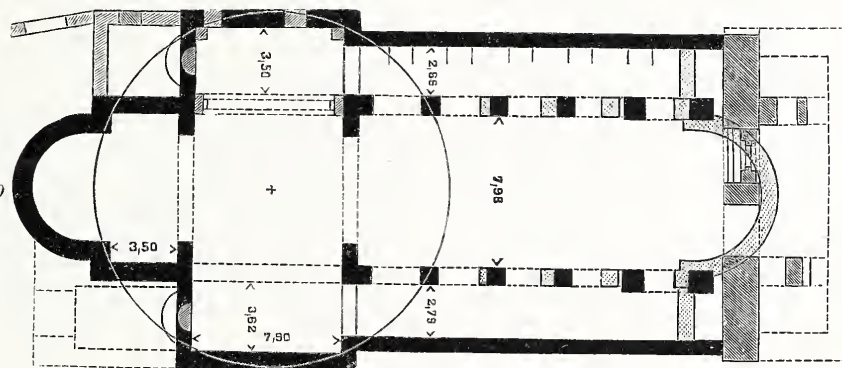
Dom in Walbeck. Grundriss.
